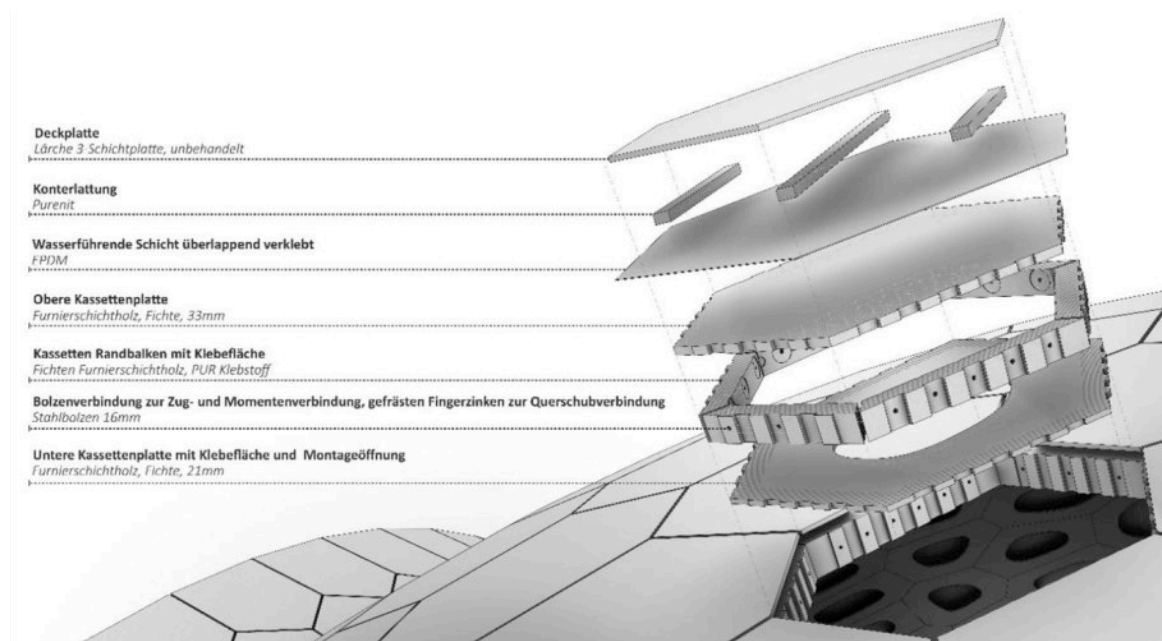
Explosionszeichnung eines Holzkassettensegments des BUGA Holzpavillons.
